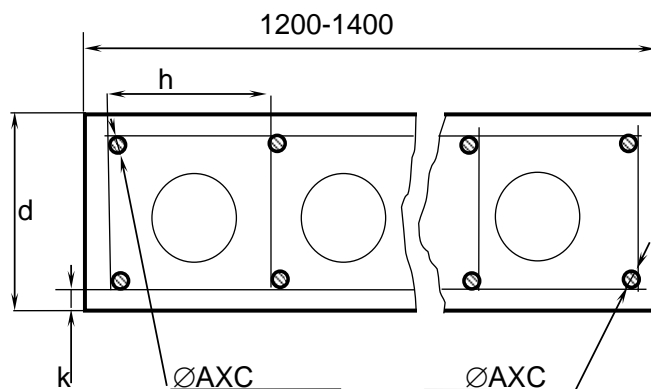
Геометричні параметри та схема армування перерізу фрагмента залізобетонної плити-зразка для випробувань
